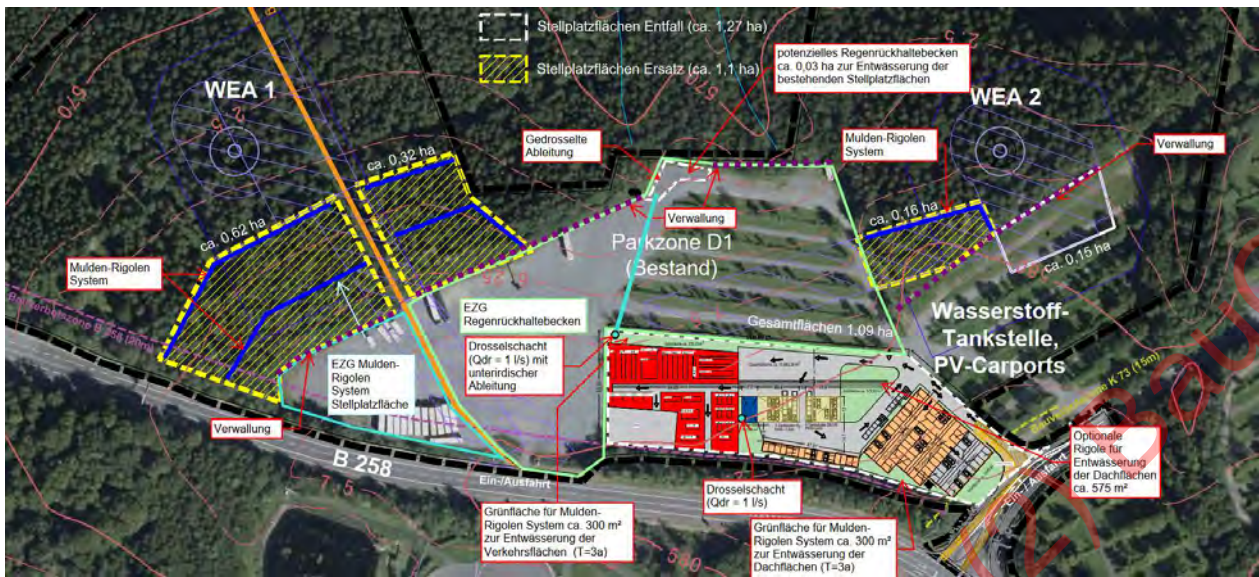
Ausschnitt: Städtebauliches Konzept mit Anmerkungen zu potenziellen Entwässerungsanlagen für die Oberflächenentwässerung (Anlage 3)
